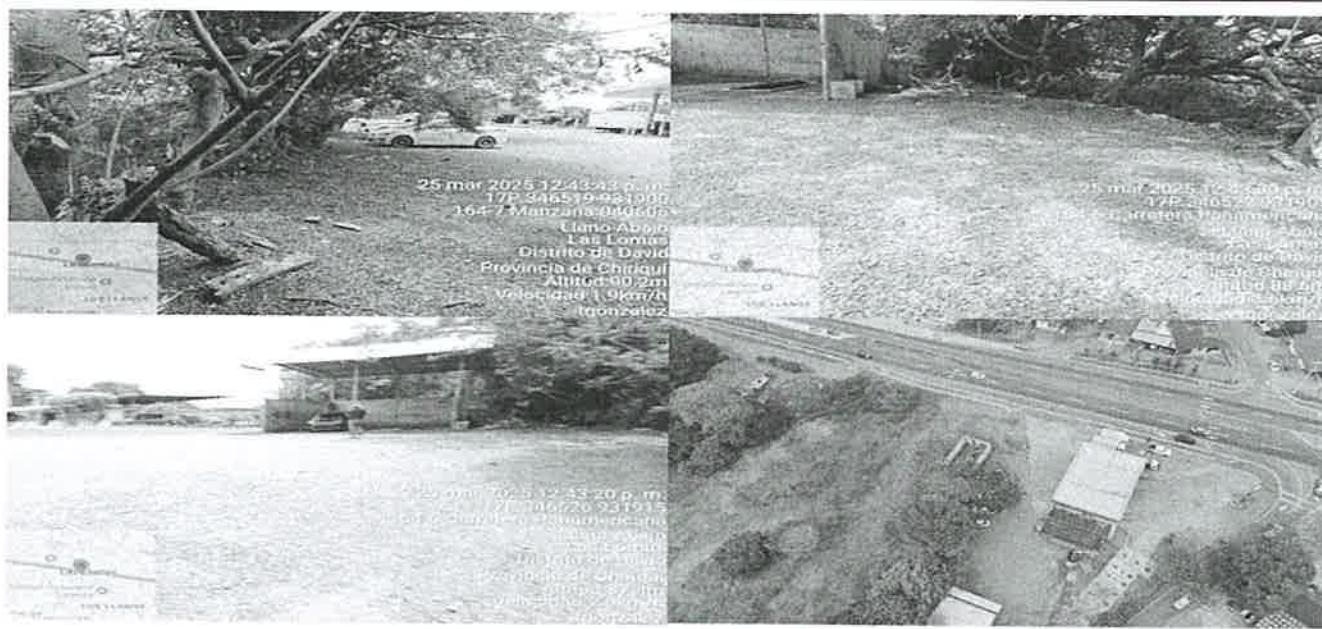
Vista parcial del terreno. Fuente: T. González. 2025
